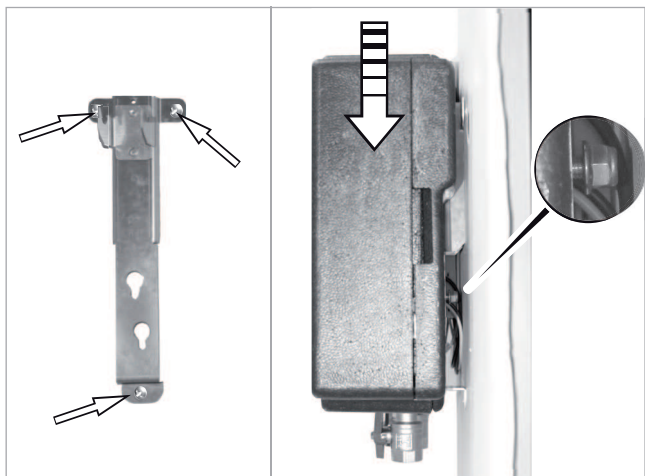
placement du rail de support, suspension de la station d'eau chaude et fixation de cette dernière
